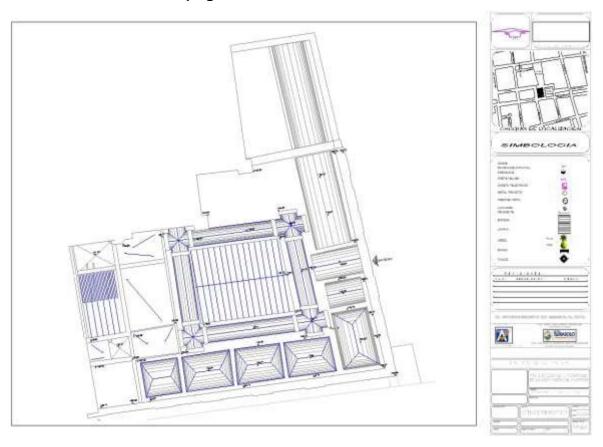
Planta de azotea estado actual. Eloísa Galván González. 2014
